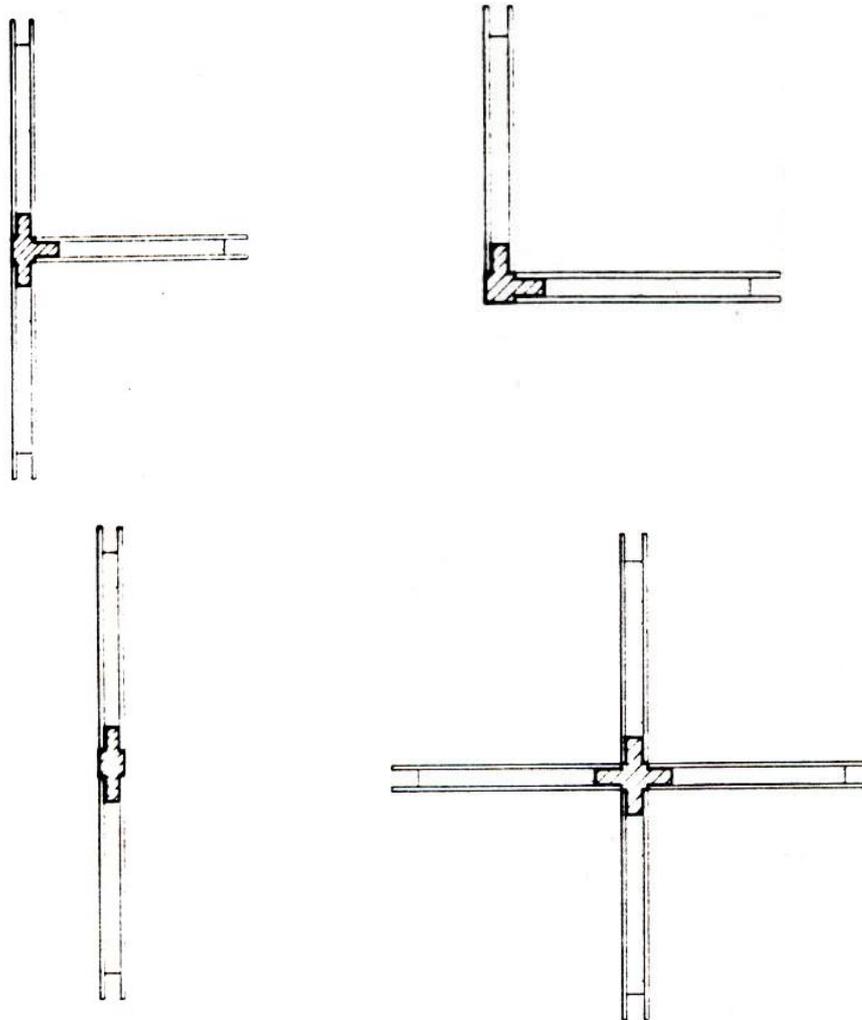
Elementos pré-moldados de argamassa armada para a interligação dos painéis
